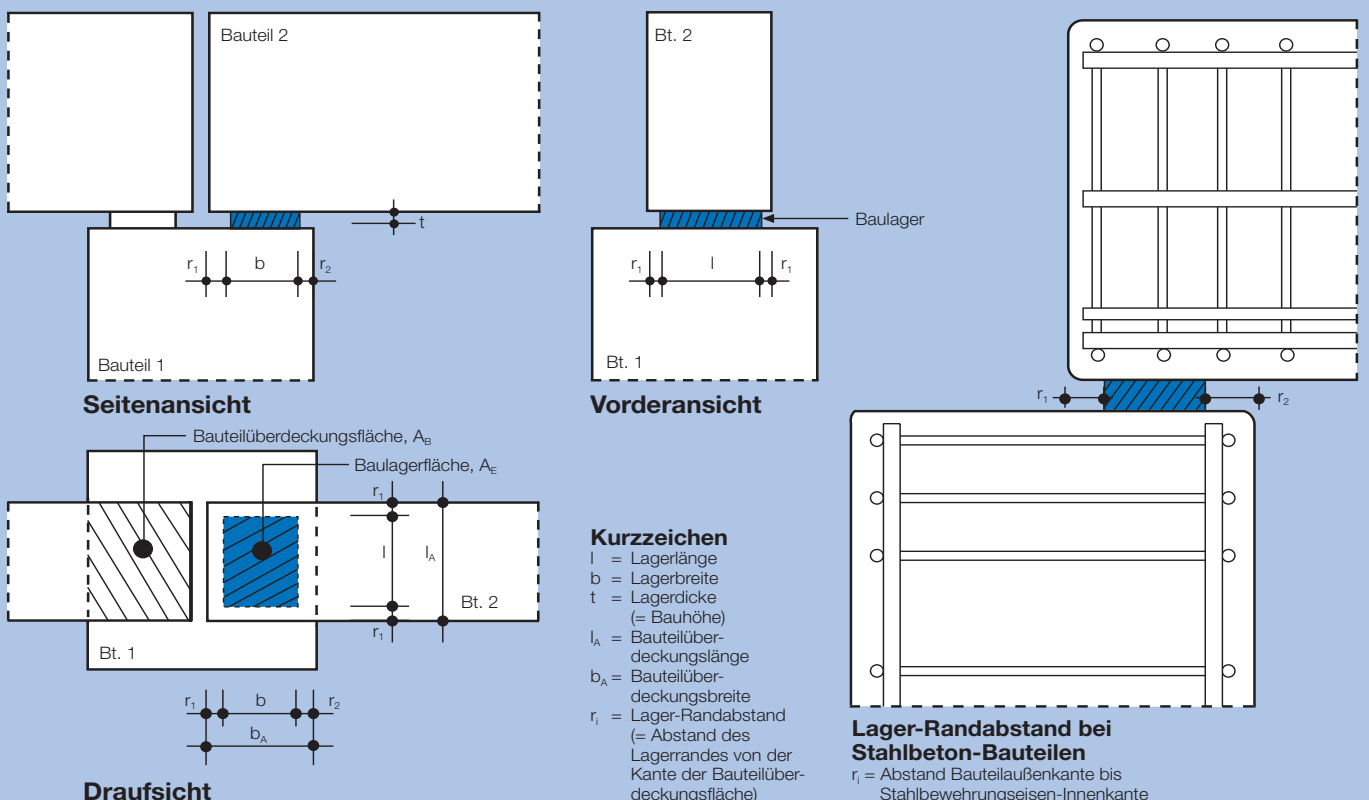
Maximale Größe der Grundrissfläche eines Elastomerlagers im Stahlbetonbau (Randabstand). Bei Bauteilen aus Holz oder Stahl sollte der Randabstand des Elastomerlagers mindestens 3 cm bzw. den 1,5fachen Wert der Lagerdicke haben.
